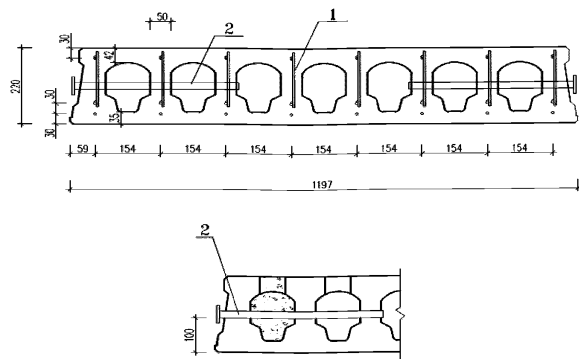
Армирование РБФ, сечение: 1 – каркасы арматурные в опорных зонах; 2 – монтажный стержень
